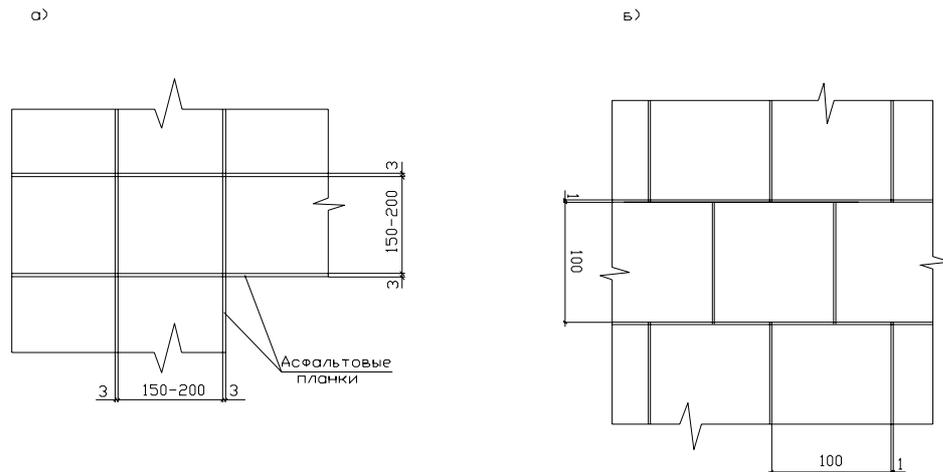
Конструкция укрепления :а) из сплошного бетона В 20;
